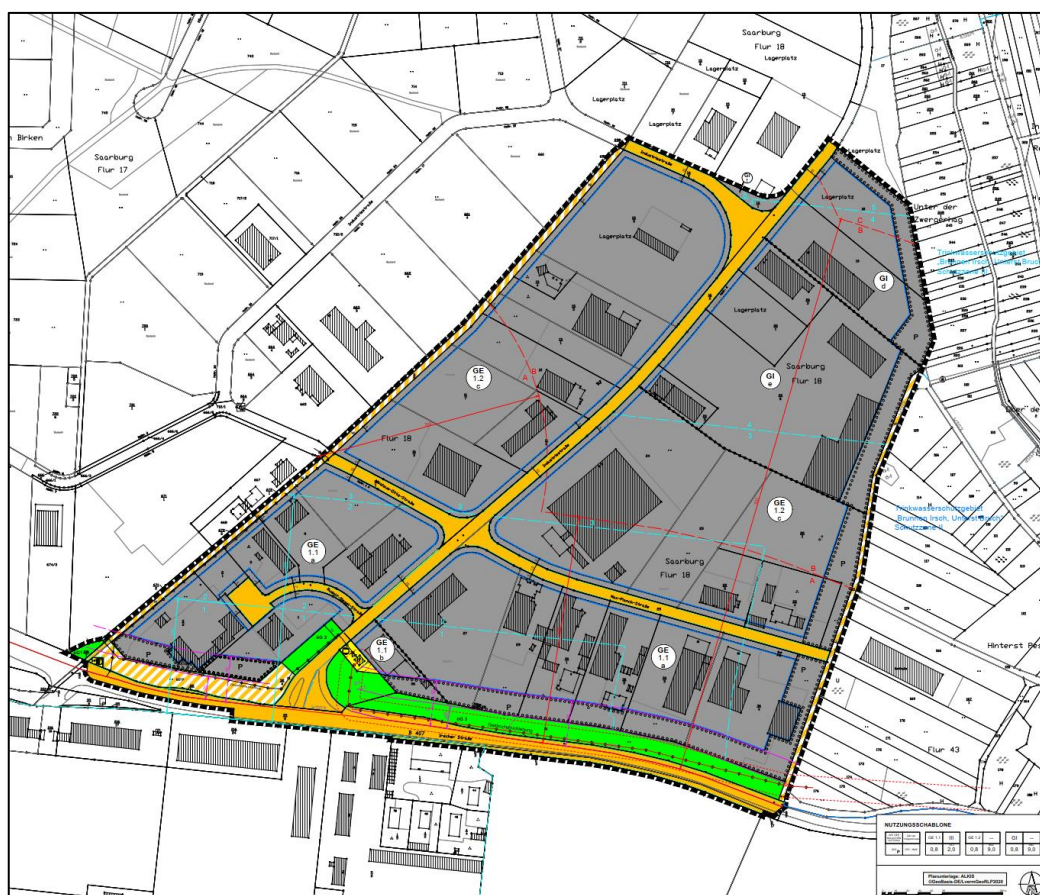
Bebauungsplan „Irscher Straße I“ – 2. Änderung
